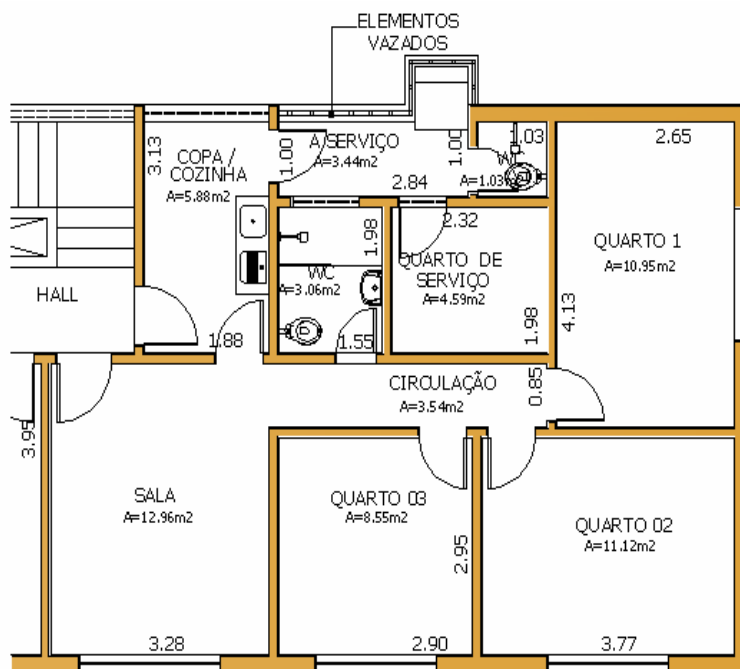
Planta baixa ilustrativa do pavimento tipo
